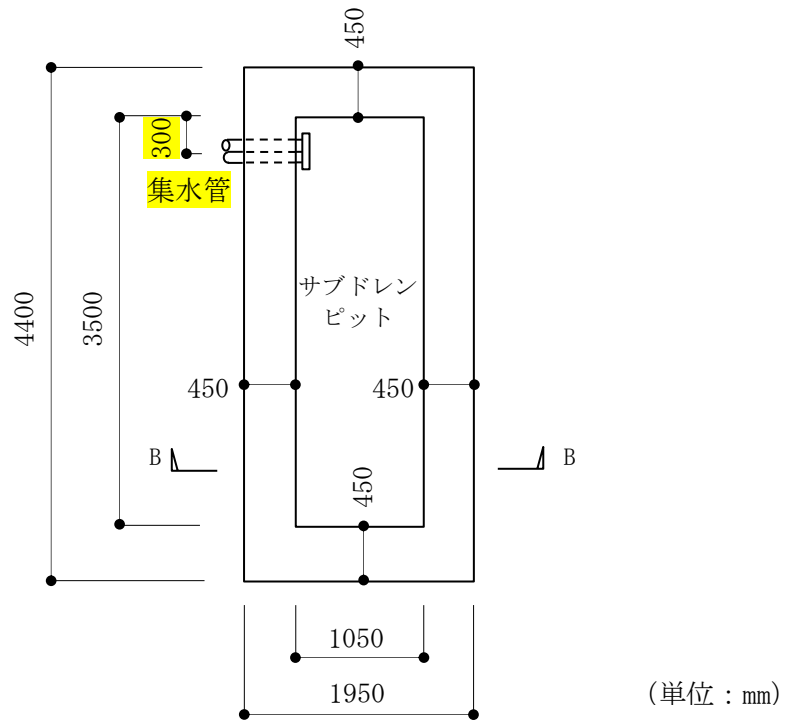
タービン建屋サブドレンピットの概略平面図 (T. M. S. L. -13.05m)
